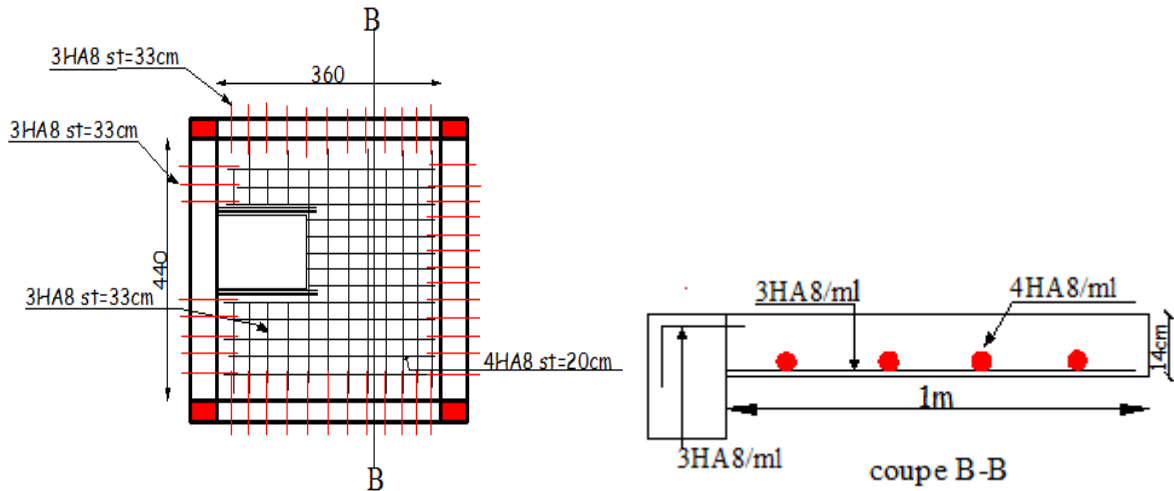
schéma de ferrailage de la dalle 2 et sa coupe B-B.
